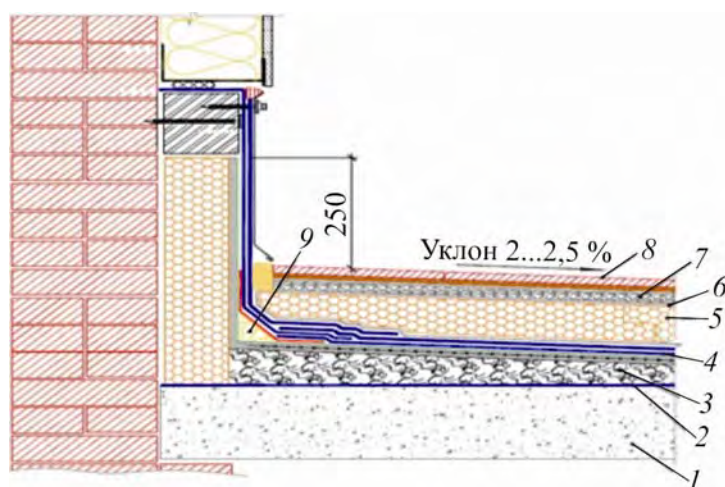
Скос из теплоизоляционного материала: 1 — железобетонная плита перекрытия; 2 — грунтовочный слой; 3 — разуклонка из керамзита; 4 — гидроизоляционный ковер из рулонных материалов; 5 — экструдированный пенополистирол; 6 — фильтрующий материал; 7 — слой гравия толщиной не менее 50 мм; 8 — настил из тротуарной плитки; 9 — теплоизоляционный материал
